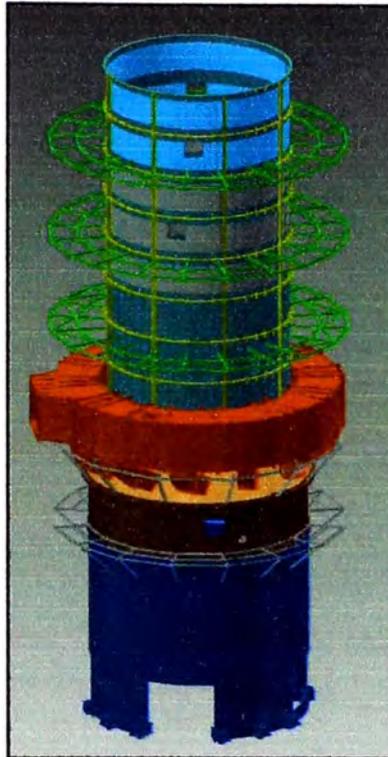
Montaje del Cuerpo de la Torre (hasta Anillo 09)
